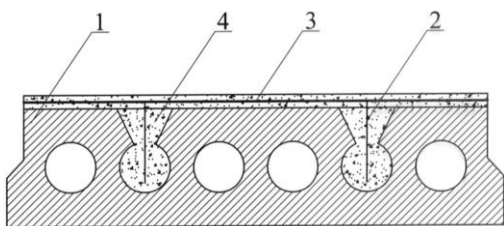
Усиление пустотной плиты перекрытия: 1 - усиливаемая плита; 2 –
